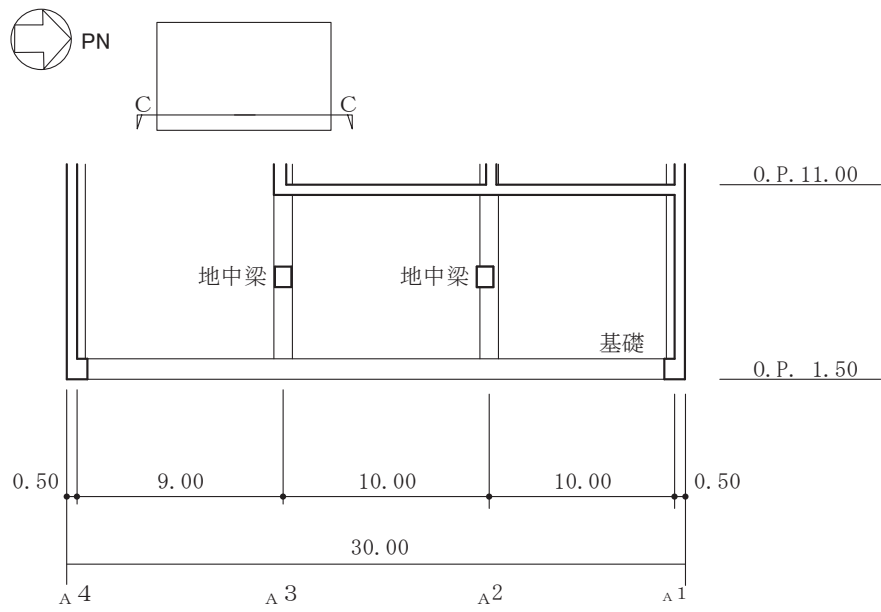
(3) 補助ボイラー建屋の基礎断面図 (C-C 断面, NS 方向)
